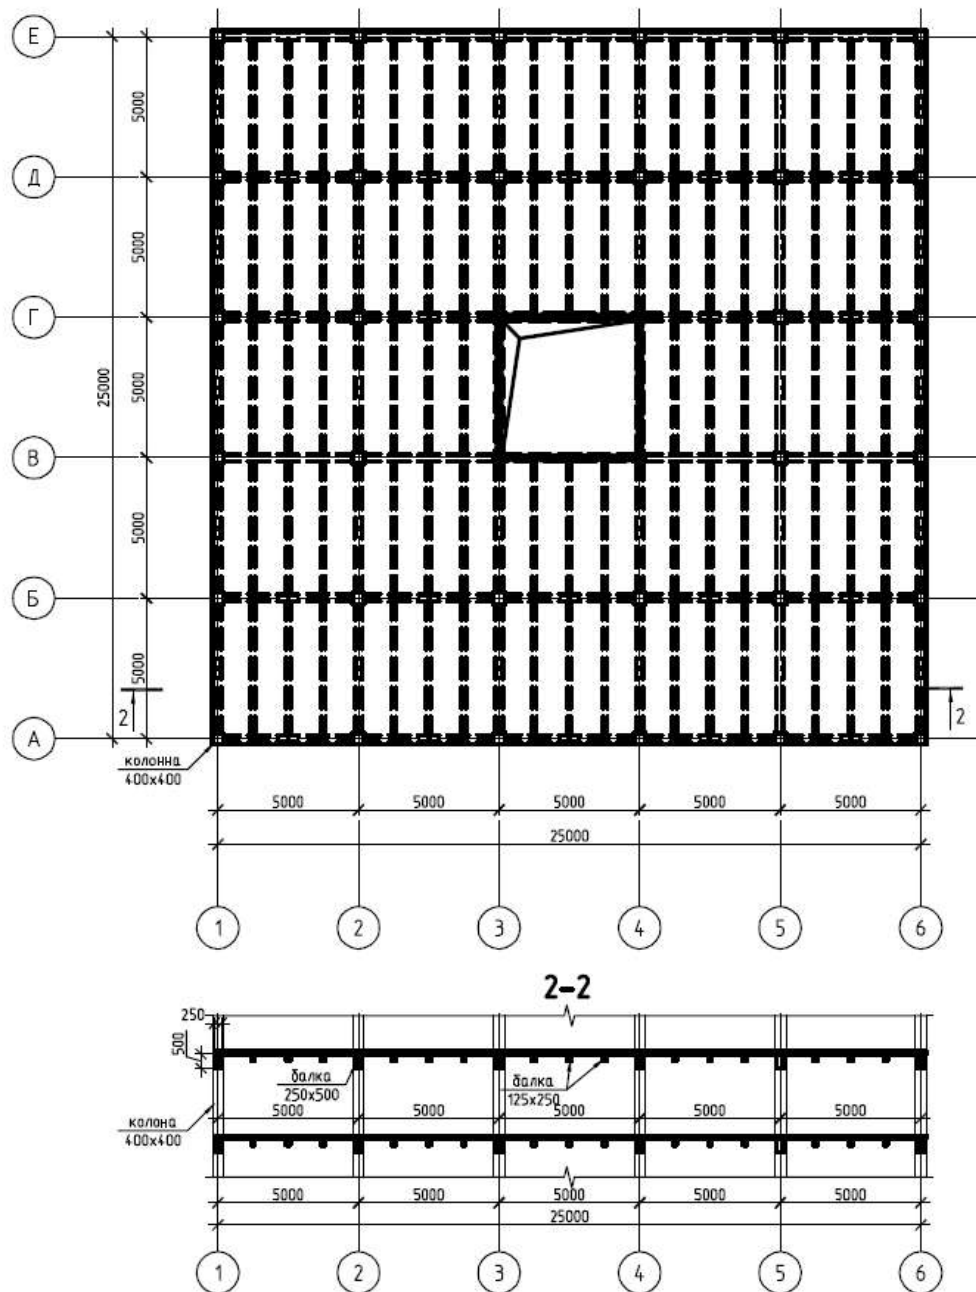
Схема будівлі із гібридним деревозалізобетонним каркасом (варіант 2)
